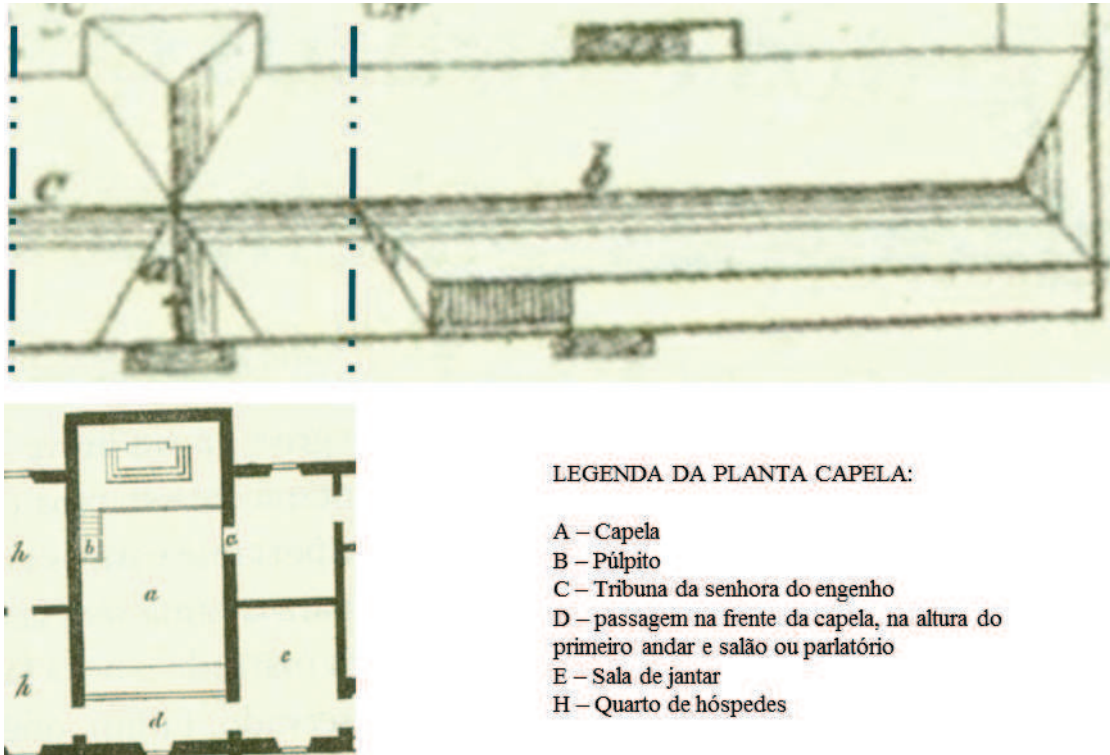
Planta de cobertura e planta baixa da casa-grande de um engenho.
